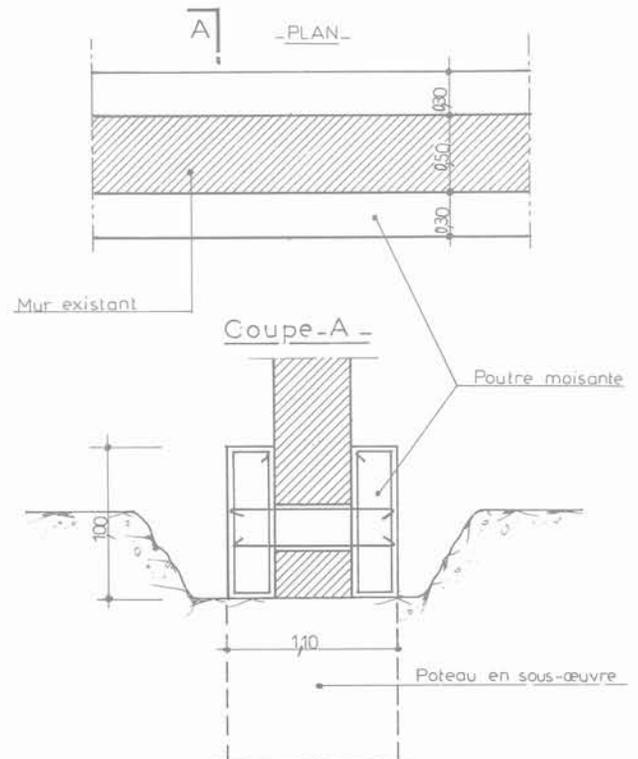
Paris 8<sup>e</sup>. Rue Paul-Baudry. Détails poutre moisante.
